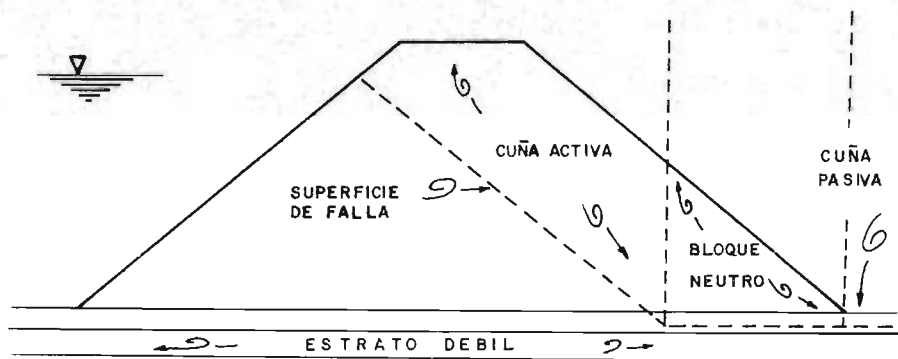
METODO DE LA CUÑA APLICADO A CIMENTACION DE TIPO FLEXIBLE
